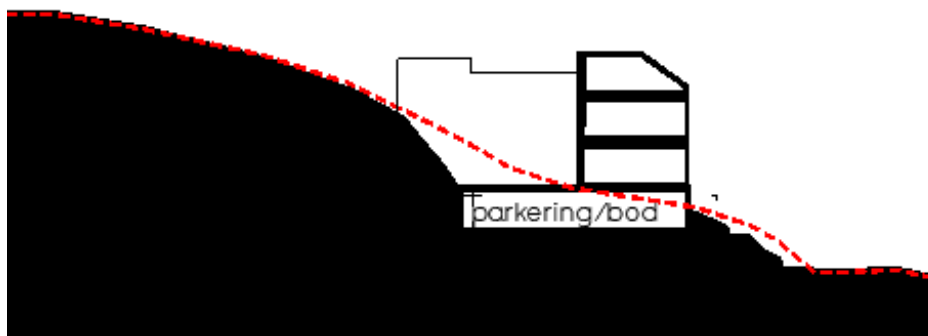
Illustrasjon vedlagt tilbakemelding fra byplan datert 15.06.2021
